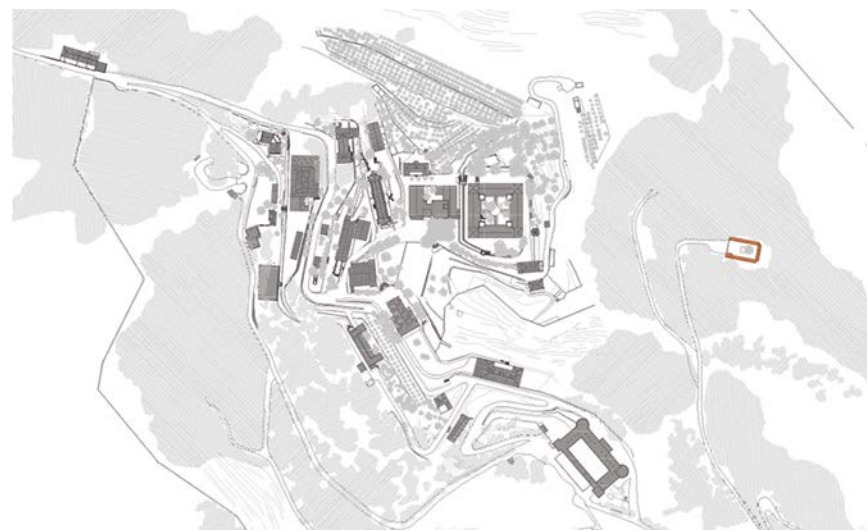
Plano de emplazamiento. Nuevo Cementerio
